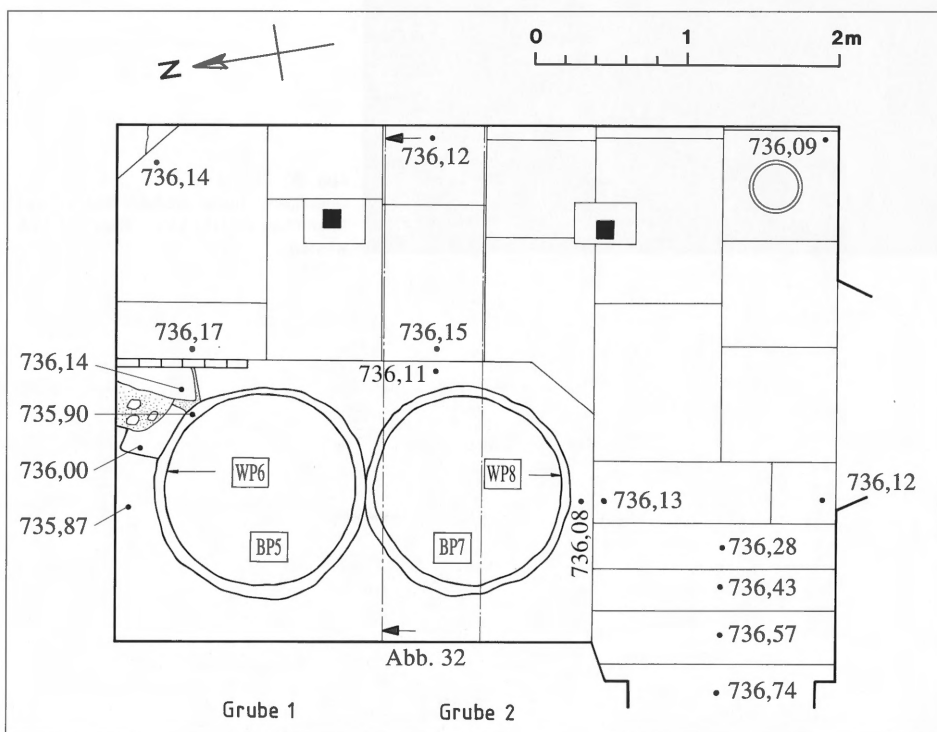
Oberägeri, Haus Gerbe. Grundriss Keller 1; zur Situierung im Hausgrundriss vgl. Abb. 8. Angegeben sind die Entnahmestellen der Wand- (WP) und Bodenproben (BP) Nr. 5 – 8 (vgl. Kap. VII.2) sowie die Lage des Ost-West-Schnittes Abb. 32.
